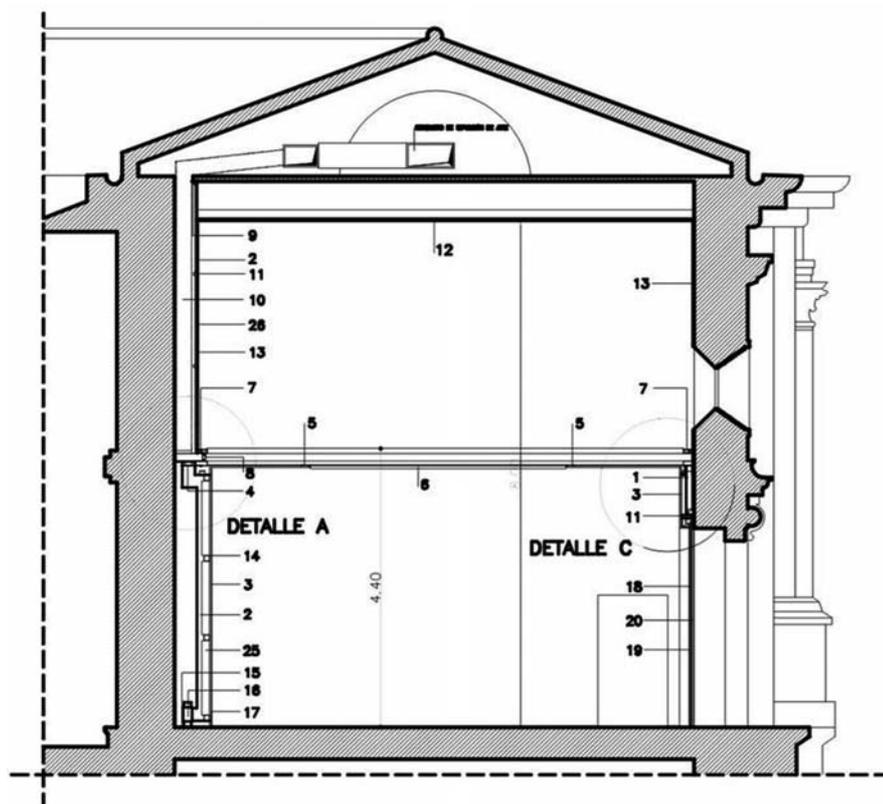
Conductos de aire por cámaras de cubierta y sala.
